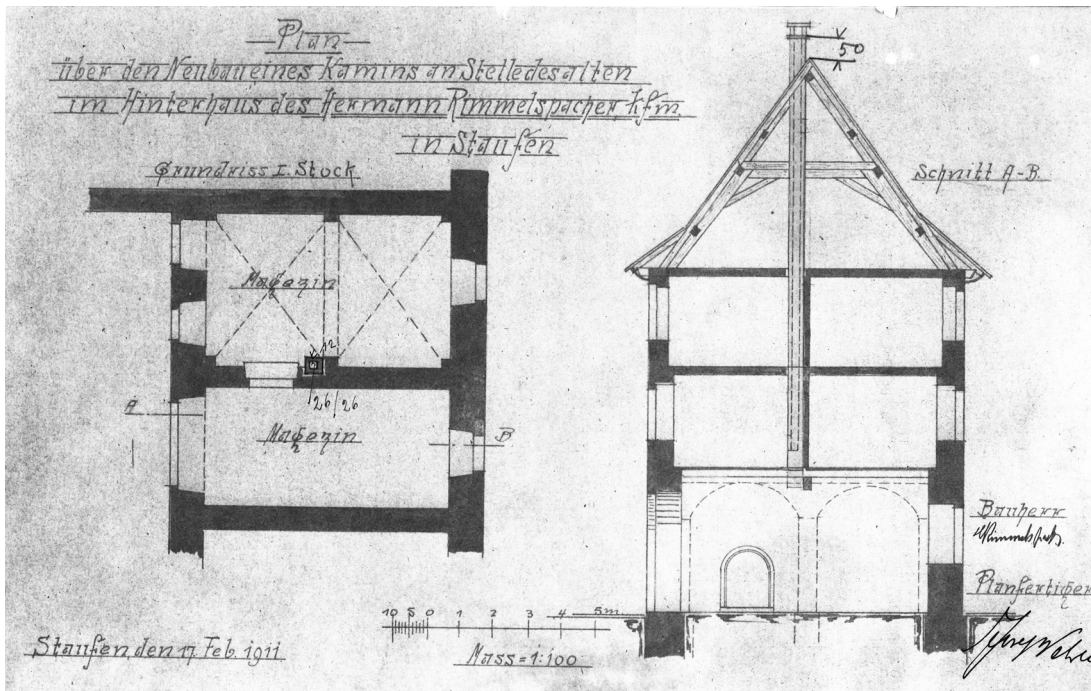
Hauptstraße 56a, Querschnitt und Grundrissausschnitt von 1911.
